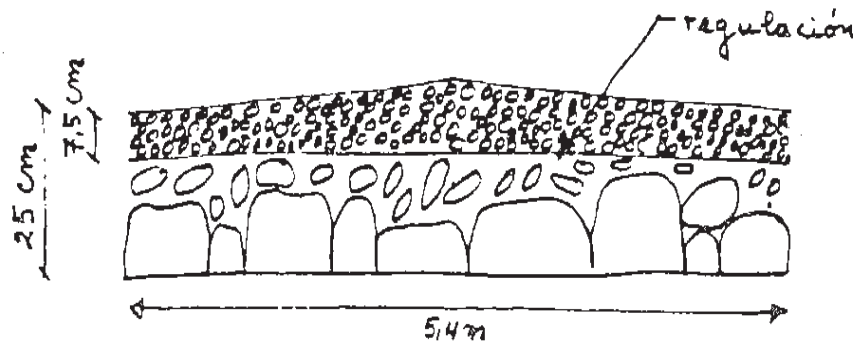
Estructura de pavimento propuesta por Pierre Marie Jerome Trésaguet.
